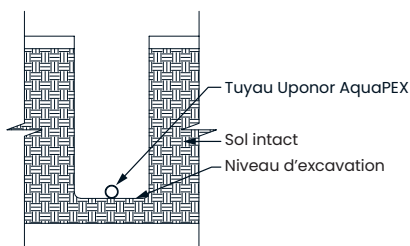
Condition du sol favorable — Si l'excavation de la tranchée se fait sans problème, installer la tuyauterie directement sur le fond préparé. Le fond doit être plat, sans trous, bosses ou cailloux.
